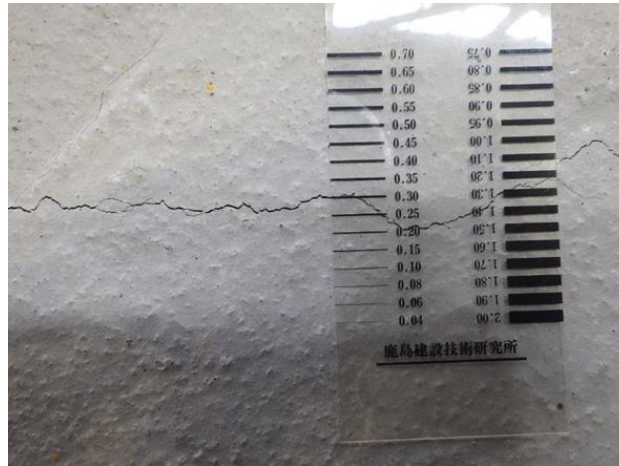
ひび割れの発生状況 (①~④貫入後)
